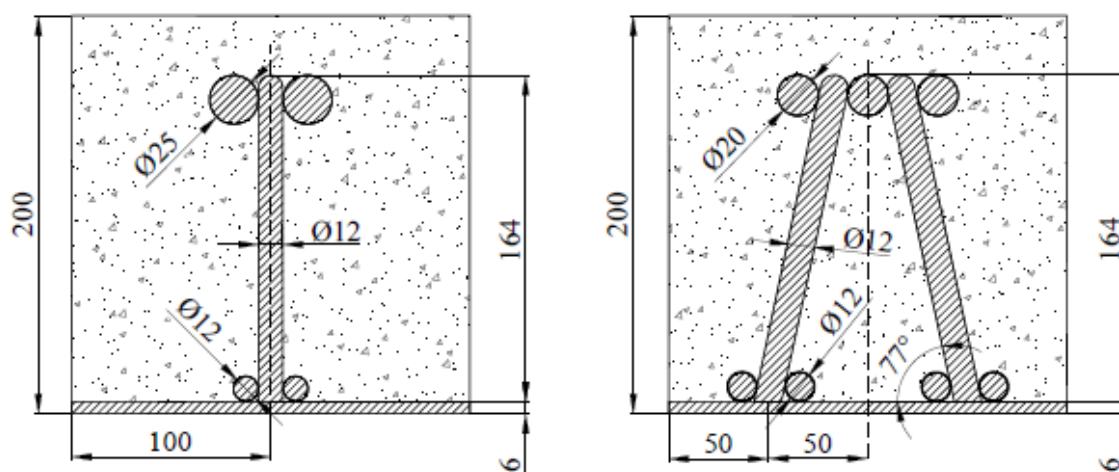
Secciones transversales fase SII, CSTCB Tipo A
